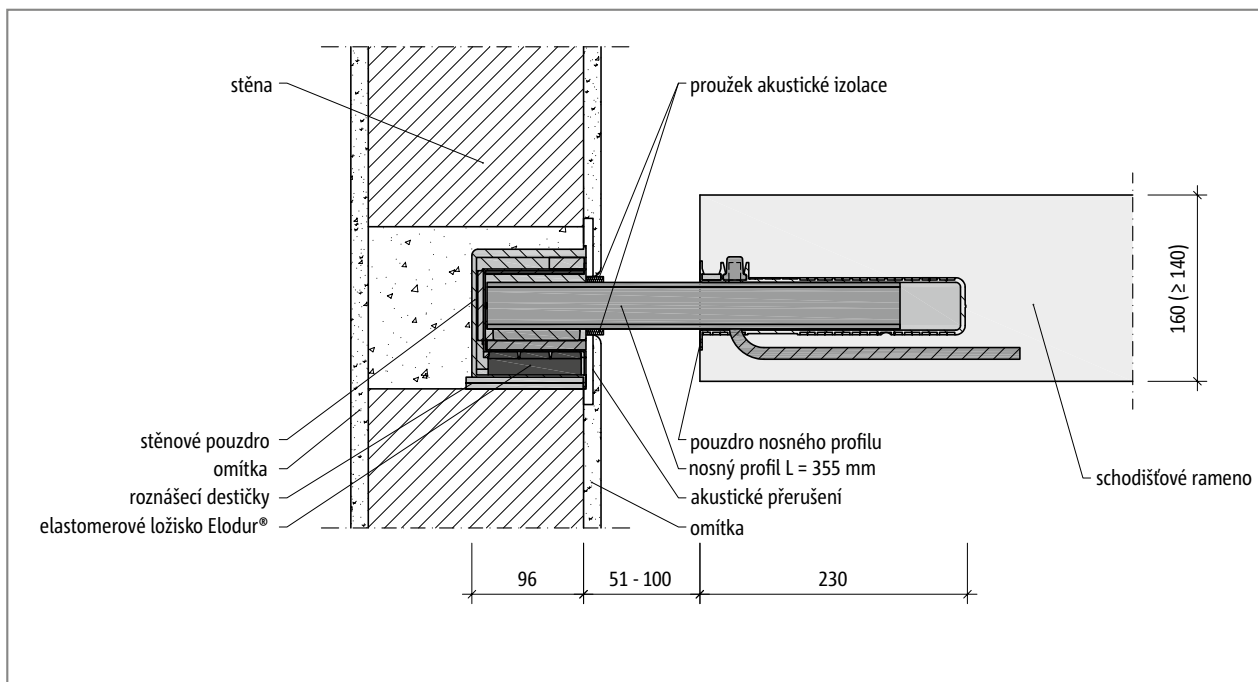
Schöck Tronsole® typ Q-FV-XL nebo Q-A2-XL: Řez napojením ramene a stěny
